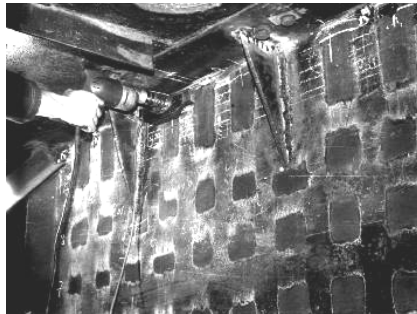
Стенка подкрановой балки, подготовленная к испытаниям магнитным методом
